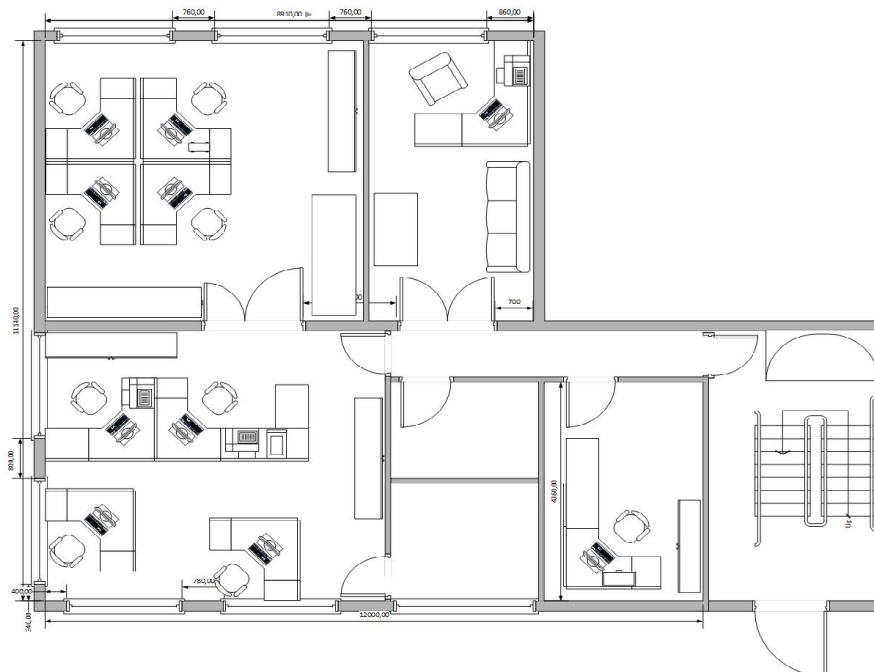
Схематичний план розташування приміщень 1-го поверху
